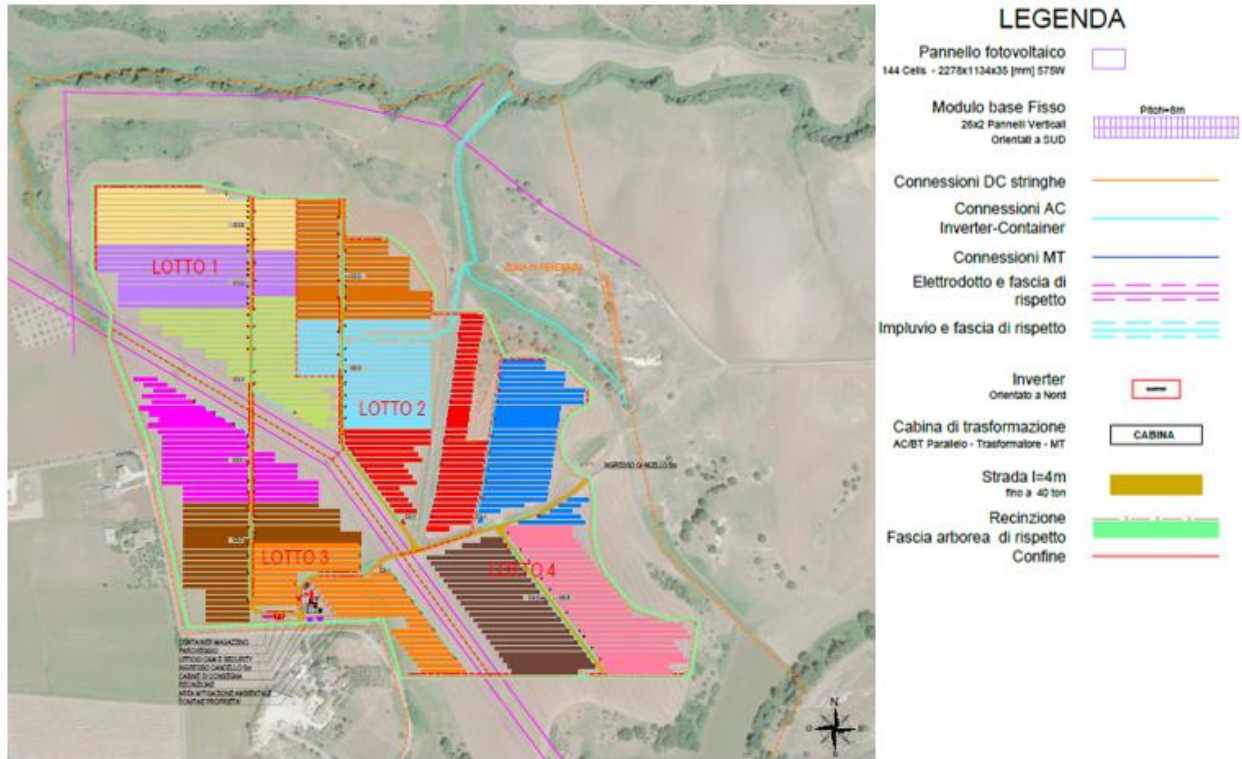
Layout impianto fotovoltaico su ortofoto
